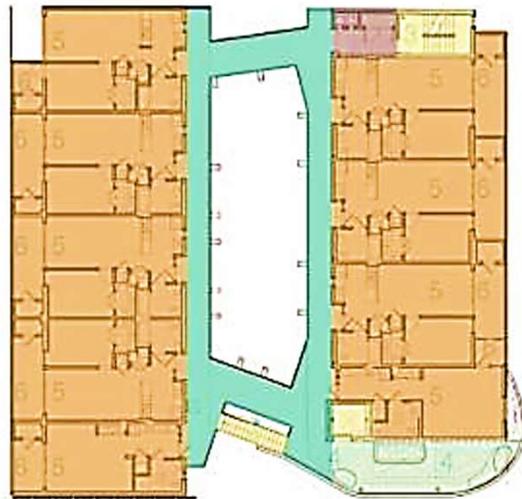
Planta Pavimento Tipo | Autor: Patrick Tighe Architecture
